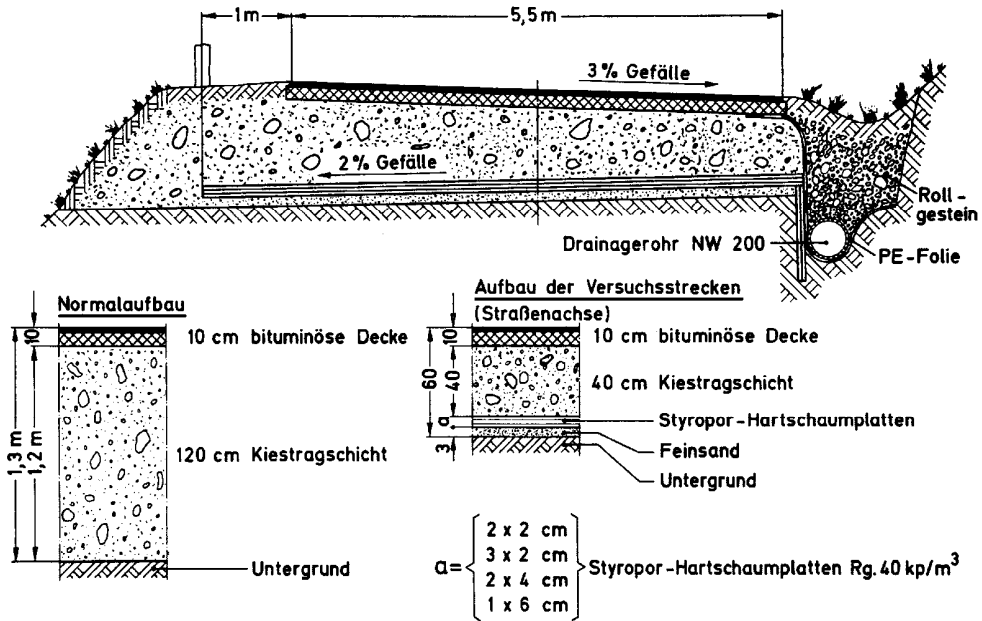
Aufbau der Versuchsstrecke Silvretta-Hochalpenstraße, Österreich, in herkömmlicher und in wärmedämmter Bauweise (aus [196])
